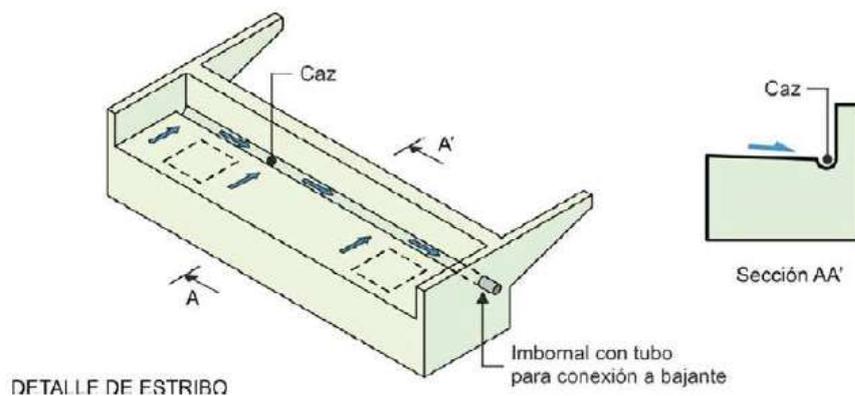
Drenaje de los estribos (Norma 5.2-IC)
